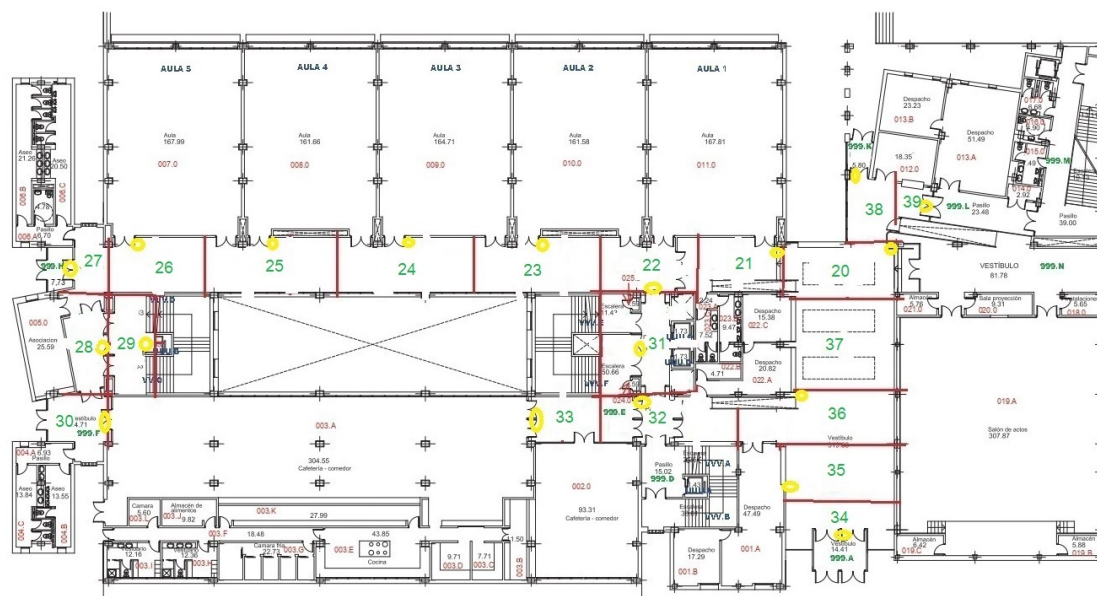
Mapeo de la planta baja de la Facultad de Informática.
